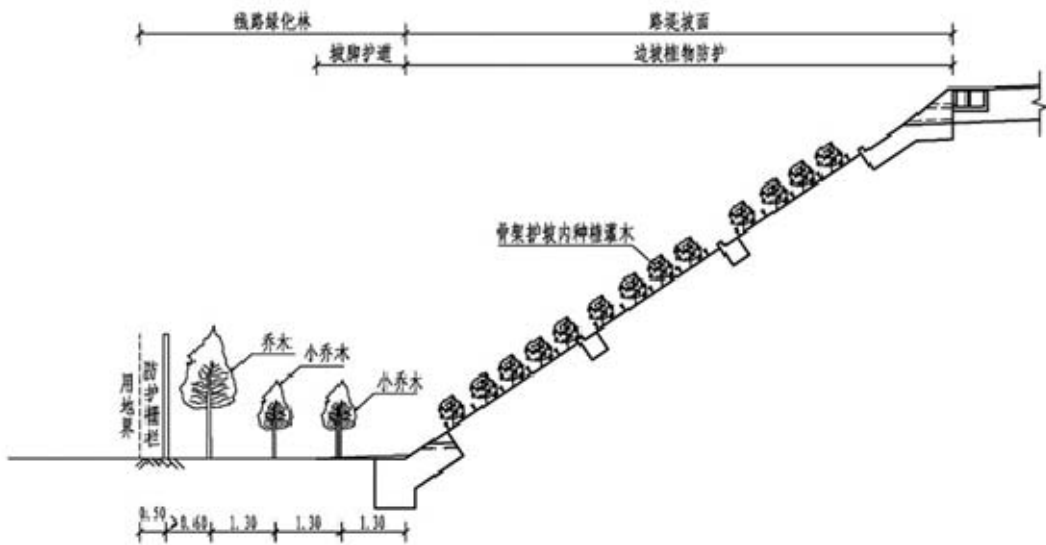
无排水沟路堤地段绿化断面示意图 (边坡高度>6m)
